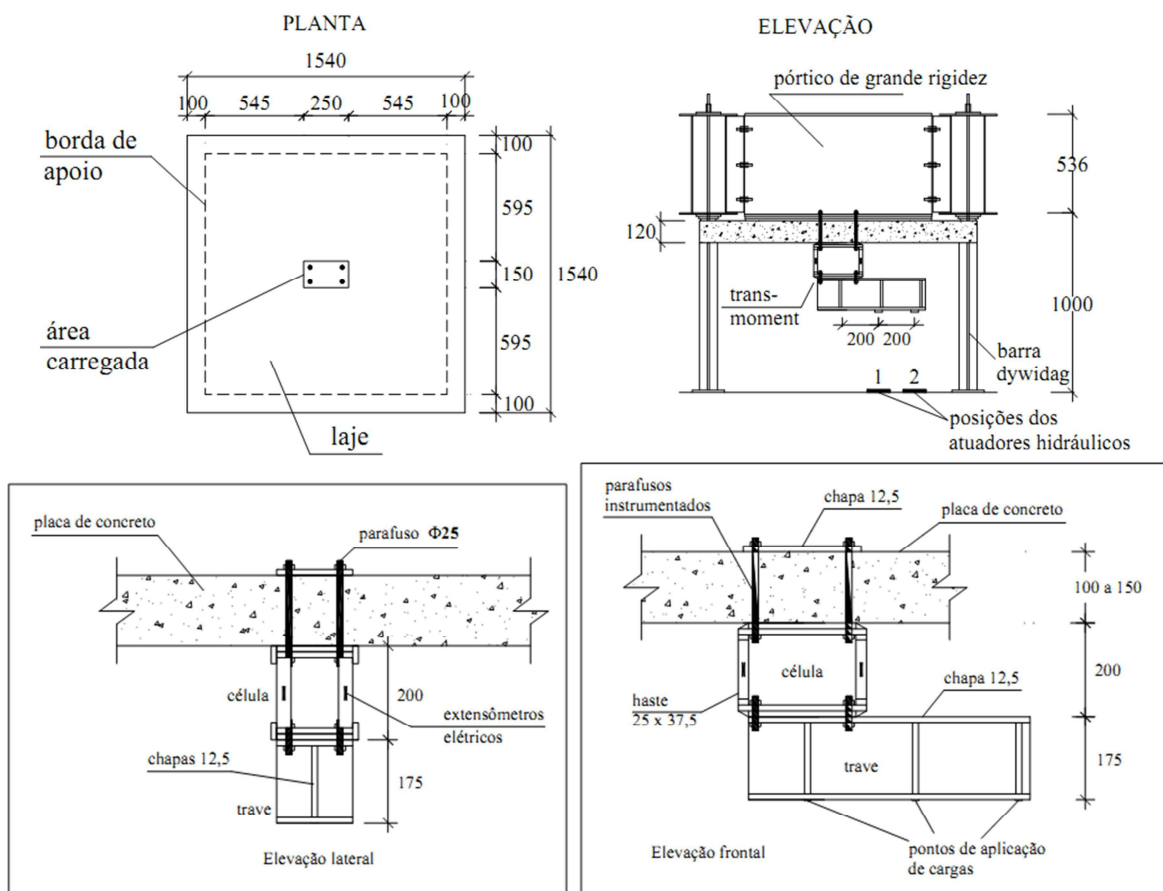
Sistema de ensaio e detalhes das lajes (Cordovil, 1995)
